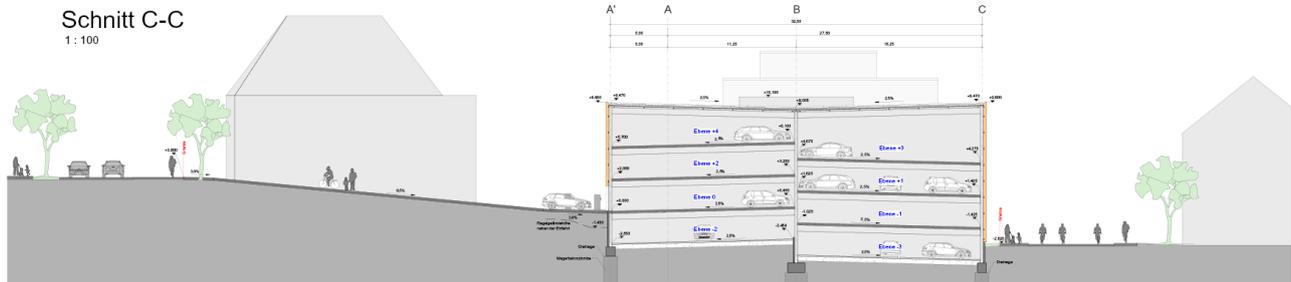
Höhenabwicklung von Westen (Kaiserstraße mit Zufahrt zum Parkhaus) nach Osten mit der Bestandsbebauung an der Körnerstraße (Scherr+Klimke Architekten, Ingenieure, Februar 2021)
